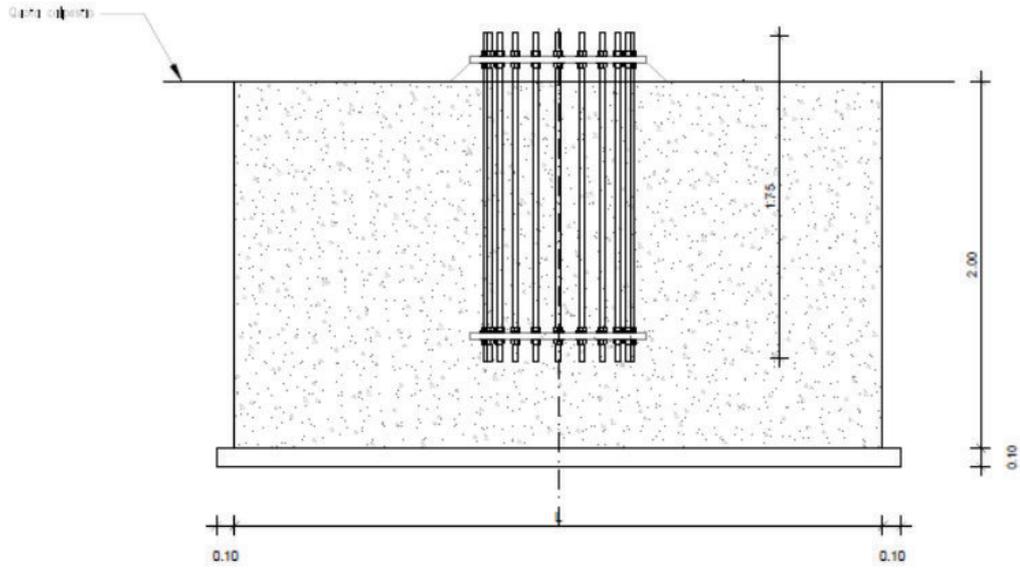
Basamento antenna GSM-R - Planimetria
